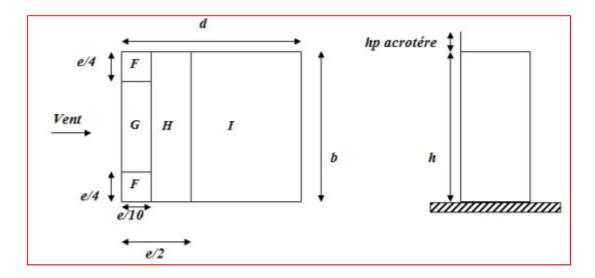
Répartition des zones de pression extérieure sur la toiture.
